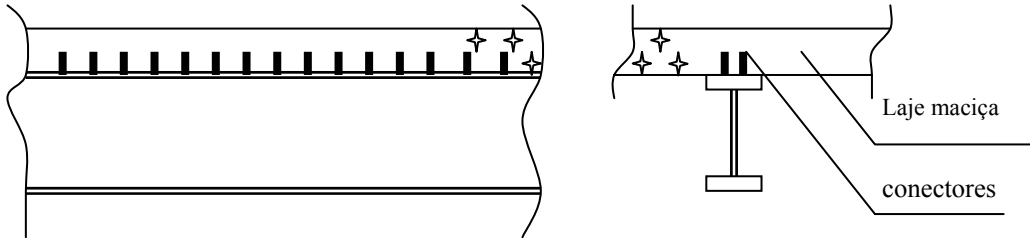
Travamento lateral contínuo da mesa comprimida de uma viga metálica, através de laje maciça com conectores
